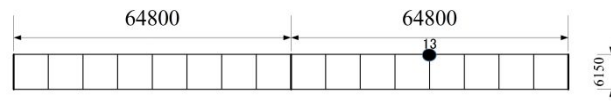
橋梁概要断面図および側面図 (unit: mm)
